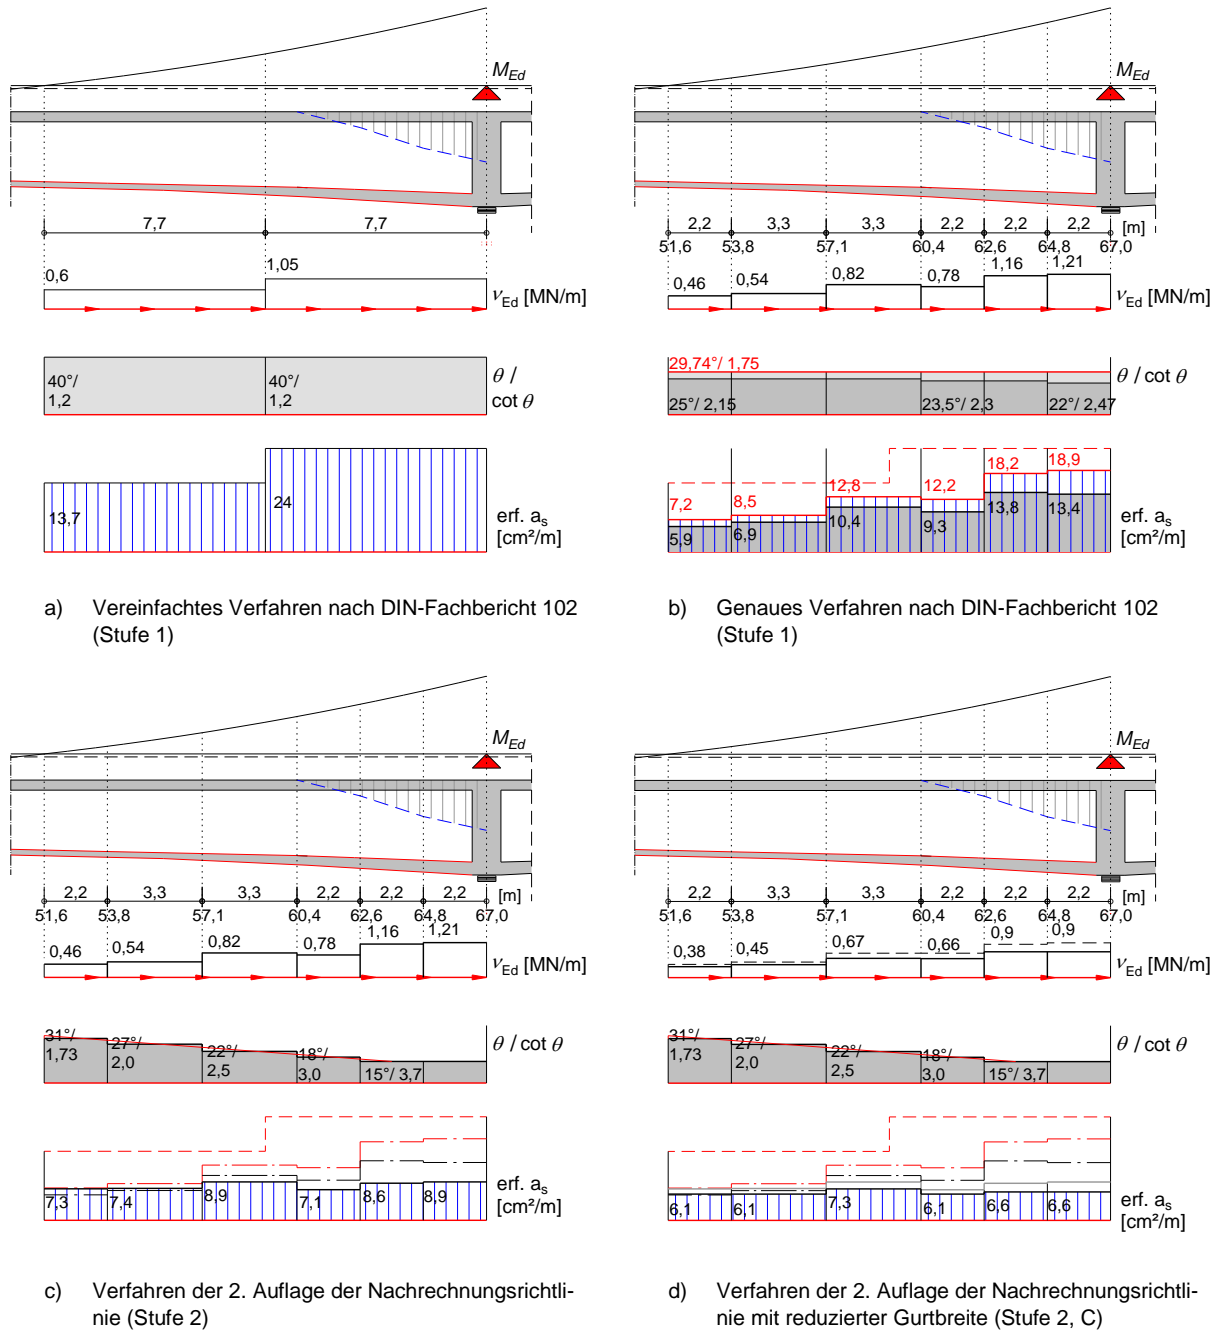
Beanspruchung je Gurtanschluss, Druckstrebenwinkel und erforderliche Anschlussbewehrung für verschiedene Berechnungsansätze
